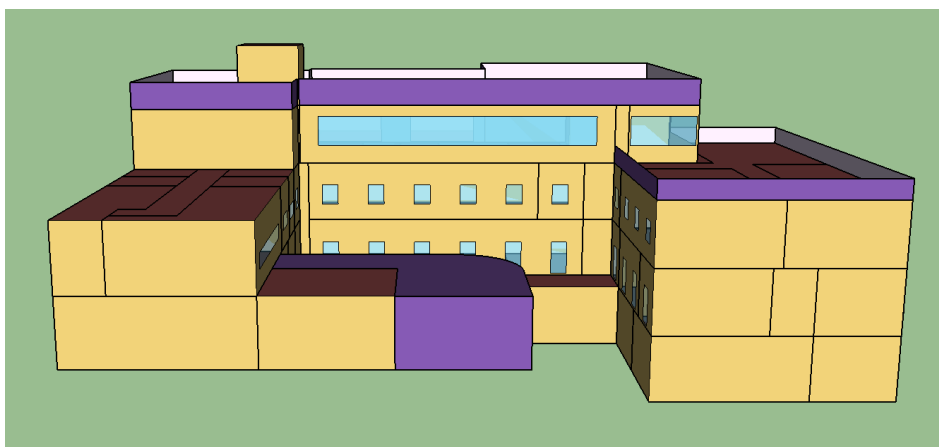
Fachada Poente do modelo geométrico em SketchUp
